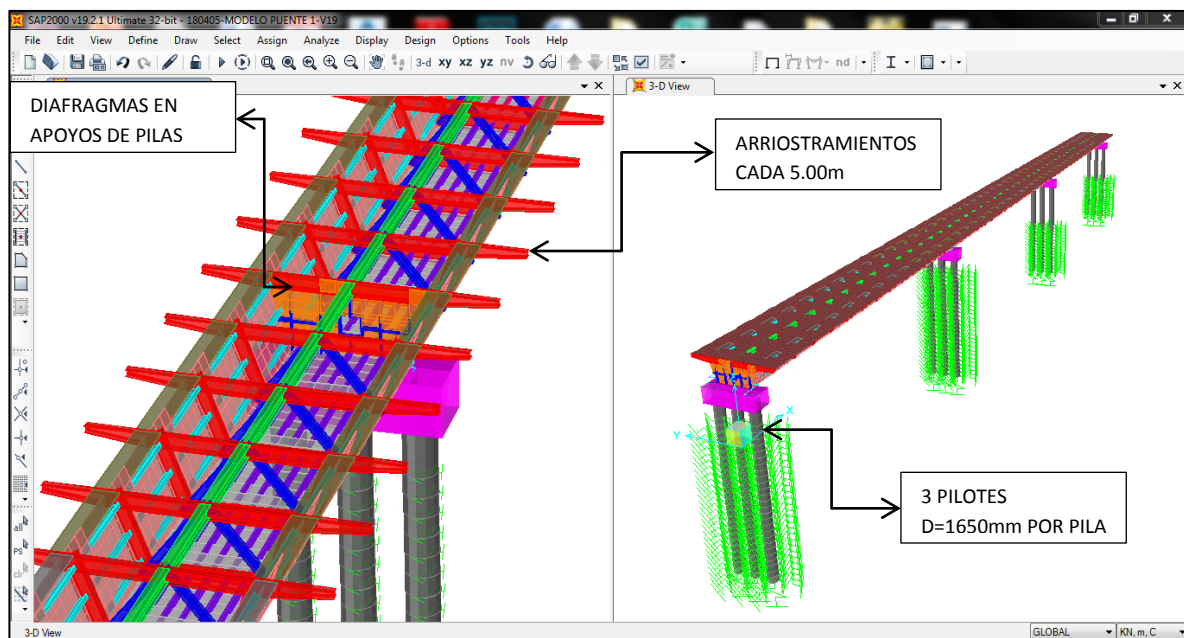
Modelo 4 en SAP2000 de 3 vanos del puente, conformado por elementos tipo frame, spring y shell (Fuente: Elaboración propia).
